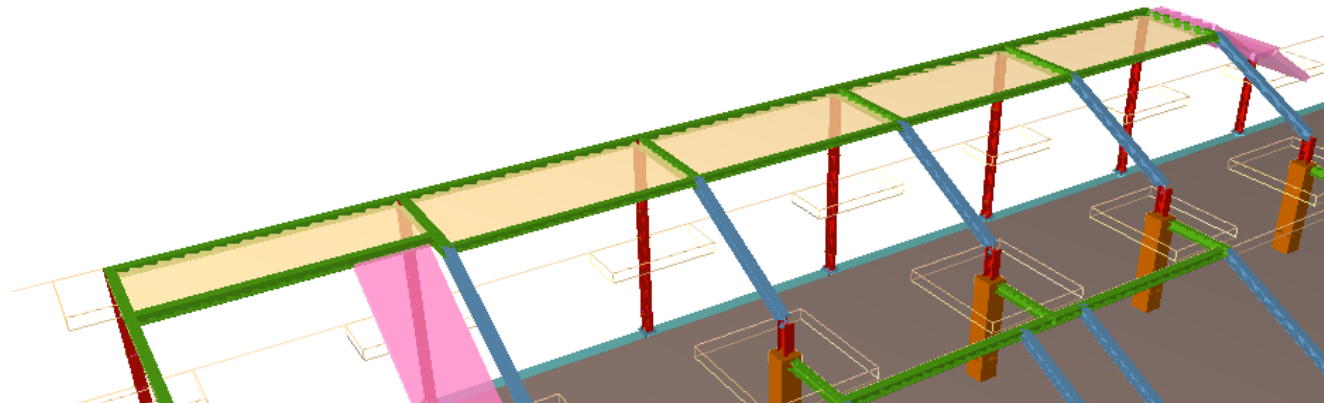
Vista en 3D del forjado de viguetas en la segunda planta. Fuente: Propia
